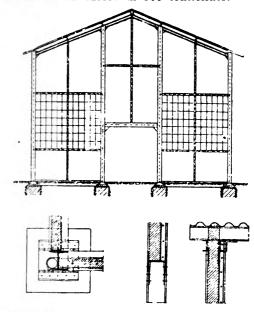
, 38, 39 e 40 - Tipo di fabbricato armato di poutrelles ad ali larghe.
